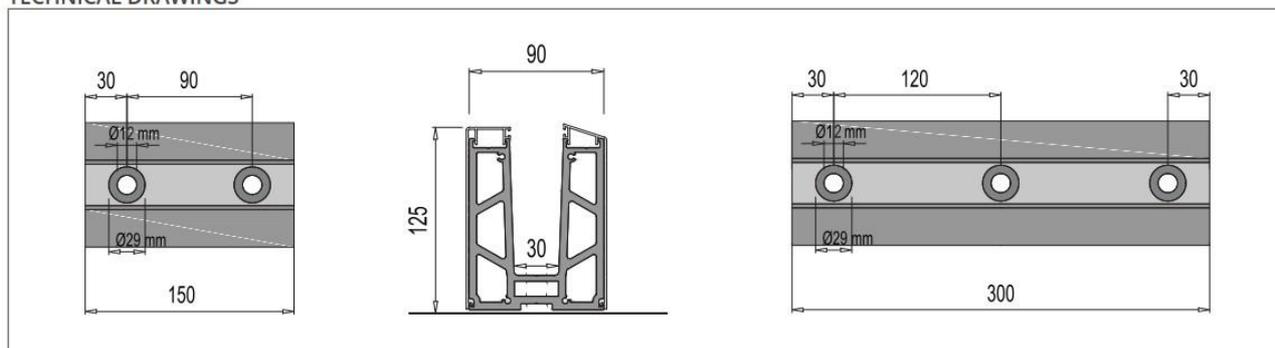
Profil KP 2300, Anordnung der Befestigungen
